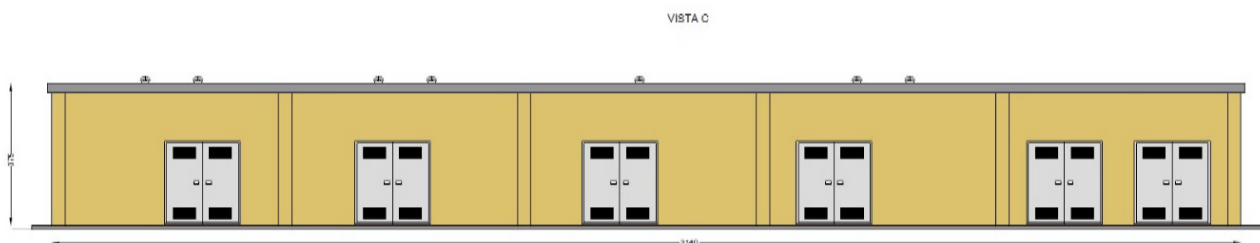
Prospetto fabbricato stazione di utenza (misure in cm)
